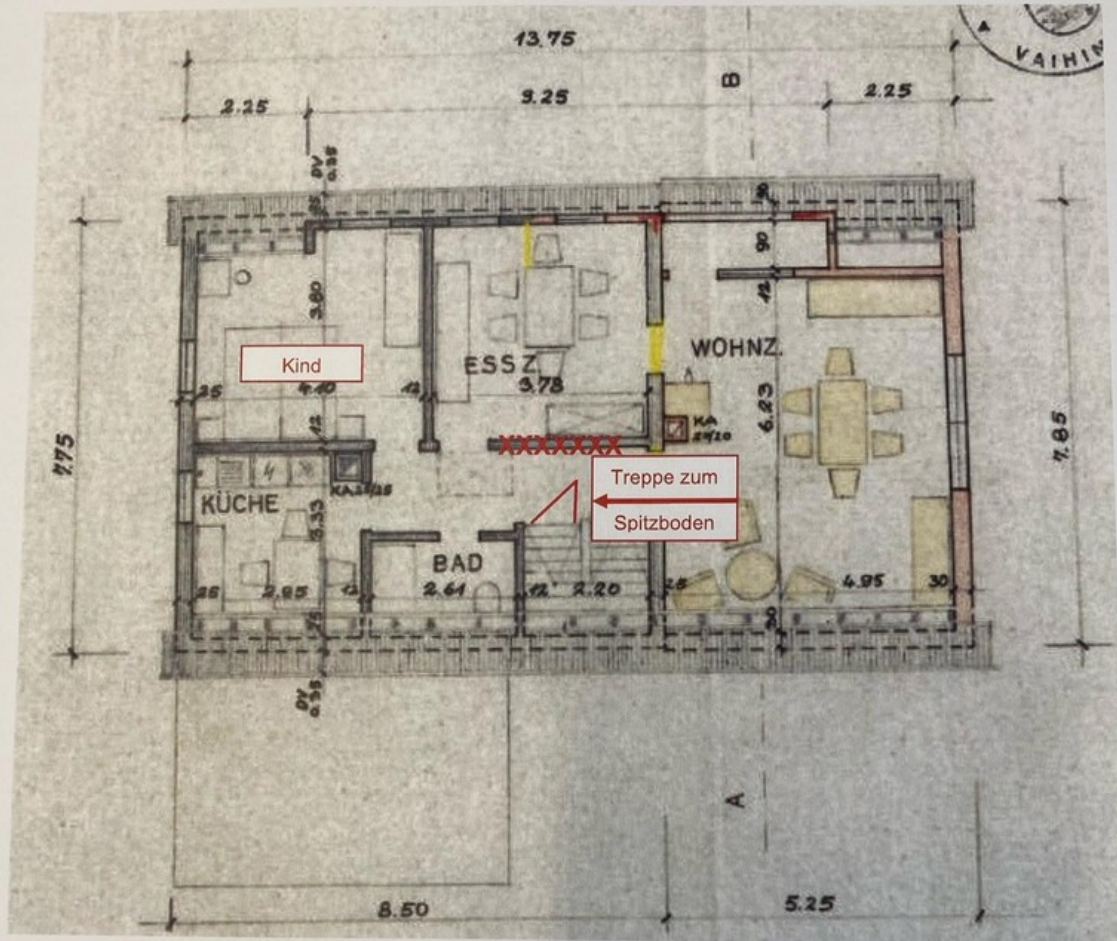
Grundriss des Dachgeschosses v. 1964 (s. Material). Dieser Plan zeigt die größte schmale Erweiterung d. 20.
